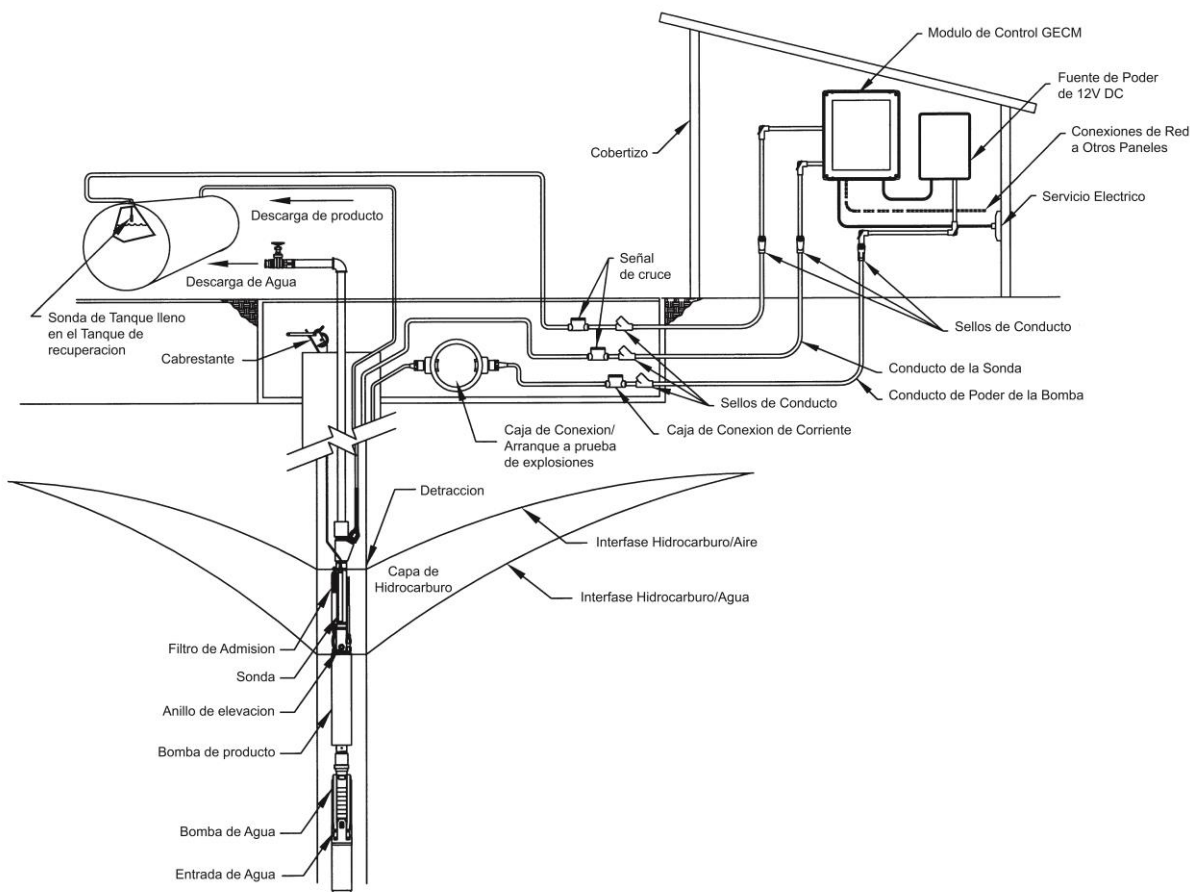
Una PSCAV lista para WTDP desplegada con el GECM opcional, fuente de poder, Sonda de Tanque Lleno y accesorios a prueba de explosión.
